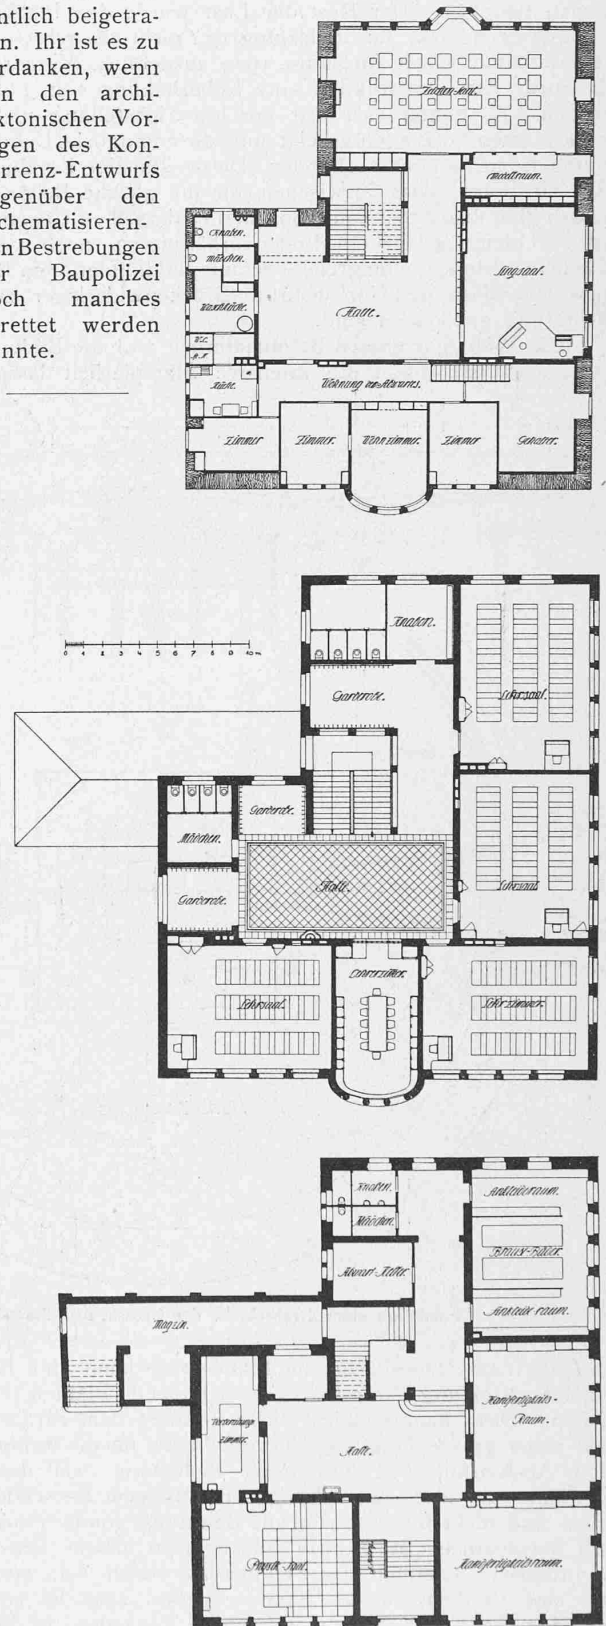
bis 4. Untergeschoss, I. Stock und Dachgeschoss. — 1:400.
